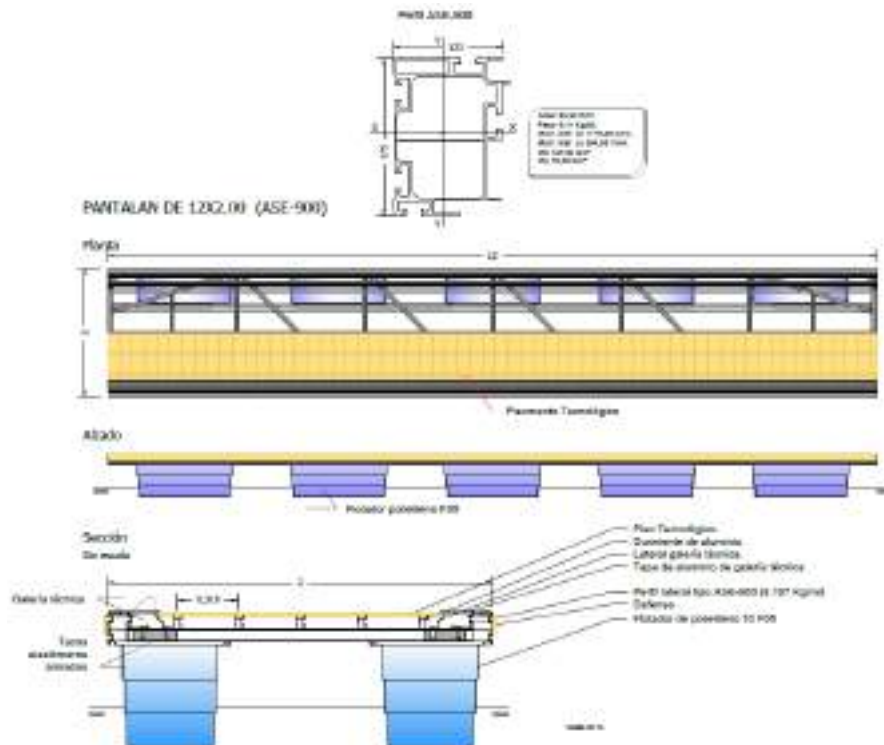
Detalle de planta y sección del pantalán flotante 2.0 m ASE-900 con flotador de hormigón.
